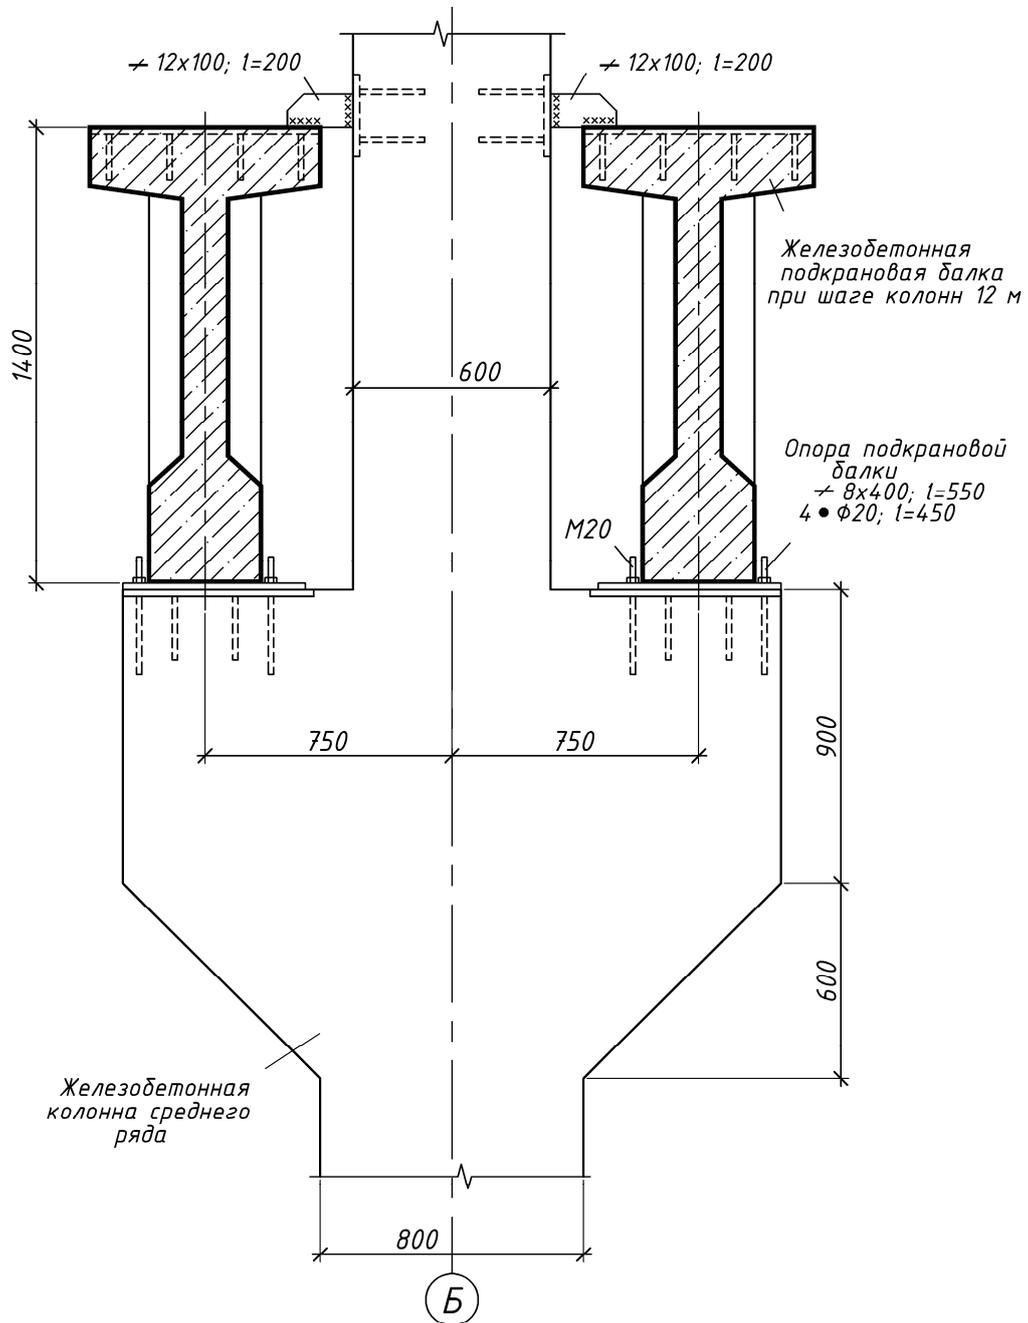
Узел опирания подкрановых балок на колонну среднего ряда
